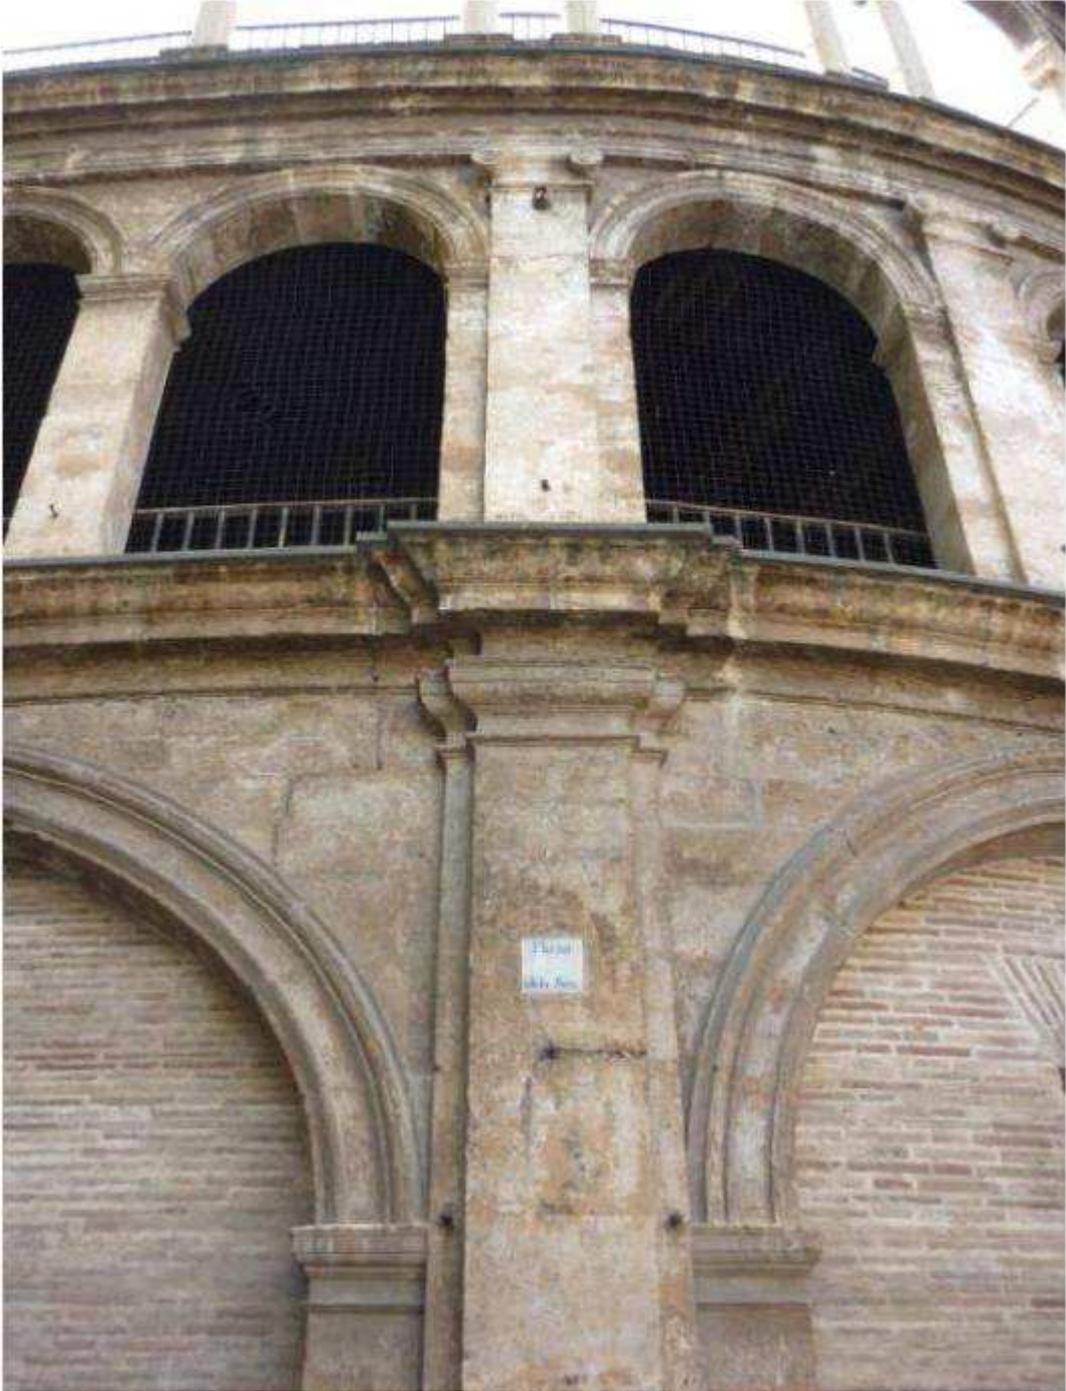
17.10 Arcos en plantas baja y primera. Los de planta primera son todos iguales de medio punto. En planta baja, a la izquierda, el correspondiente al tramo central, apainelado. A la derecha, arco de medio punto.
